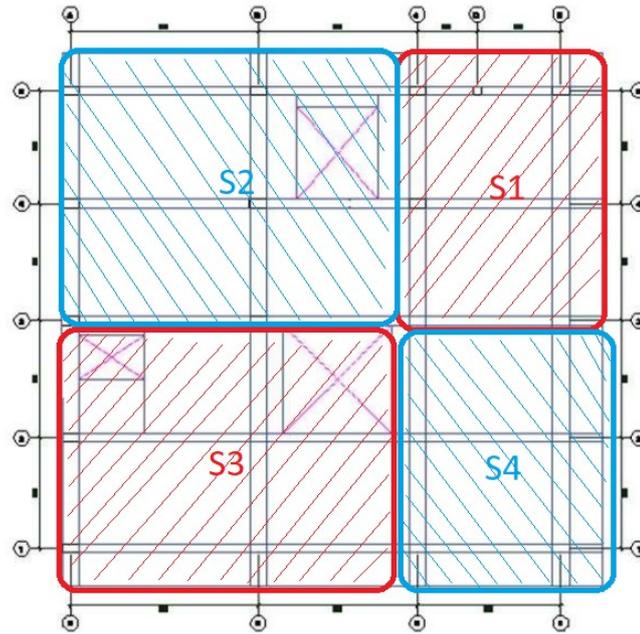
Sectorización de la edificación con concreto vaciado in situ. Adaptado de Cruz (2018)
